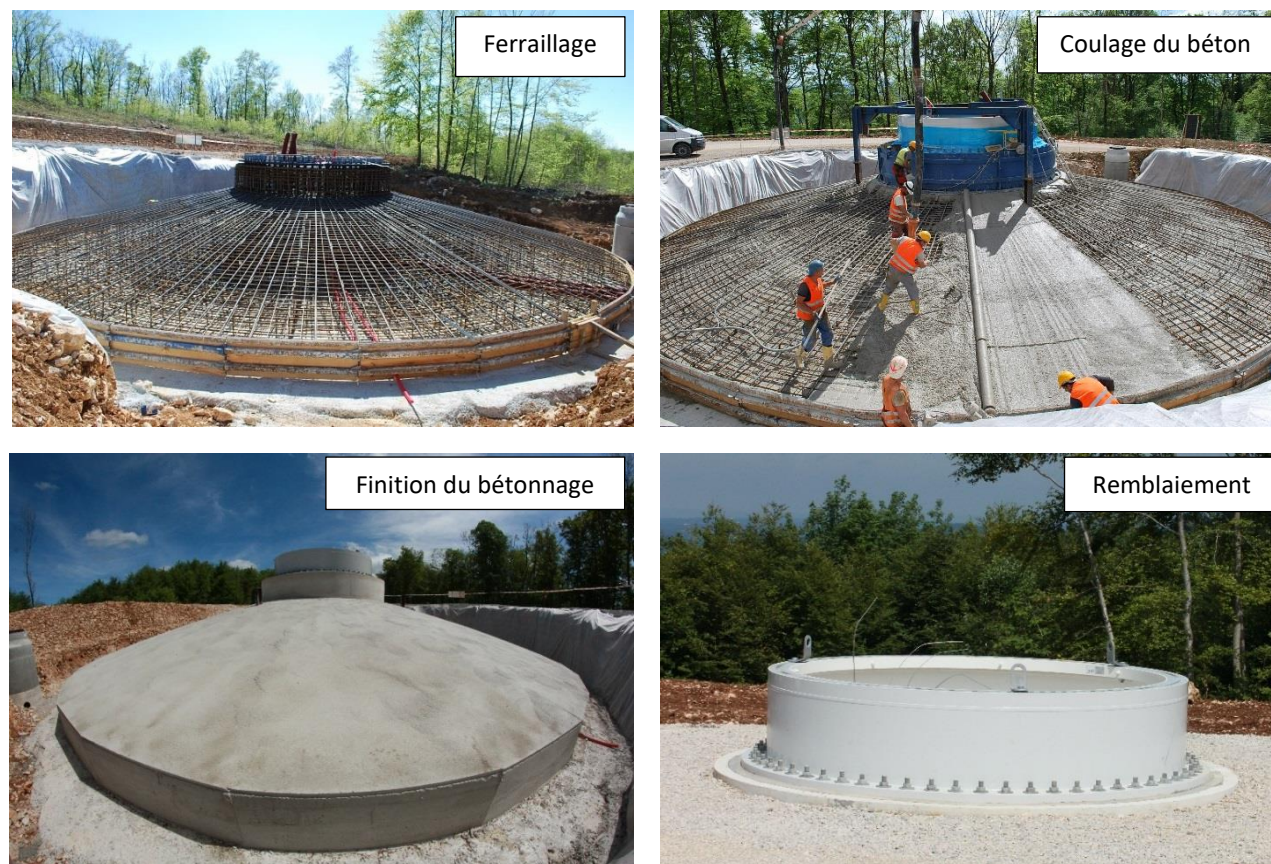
Fondation type d'une éolienne avec le système de fixation du mât (Opale)
